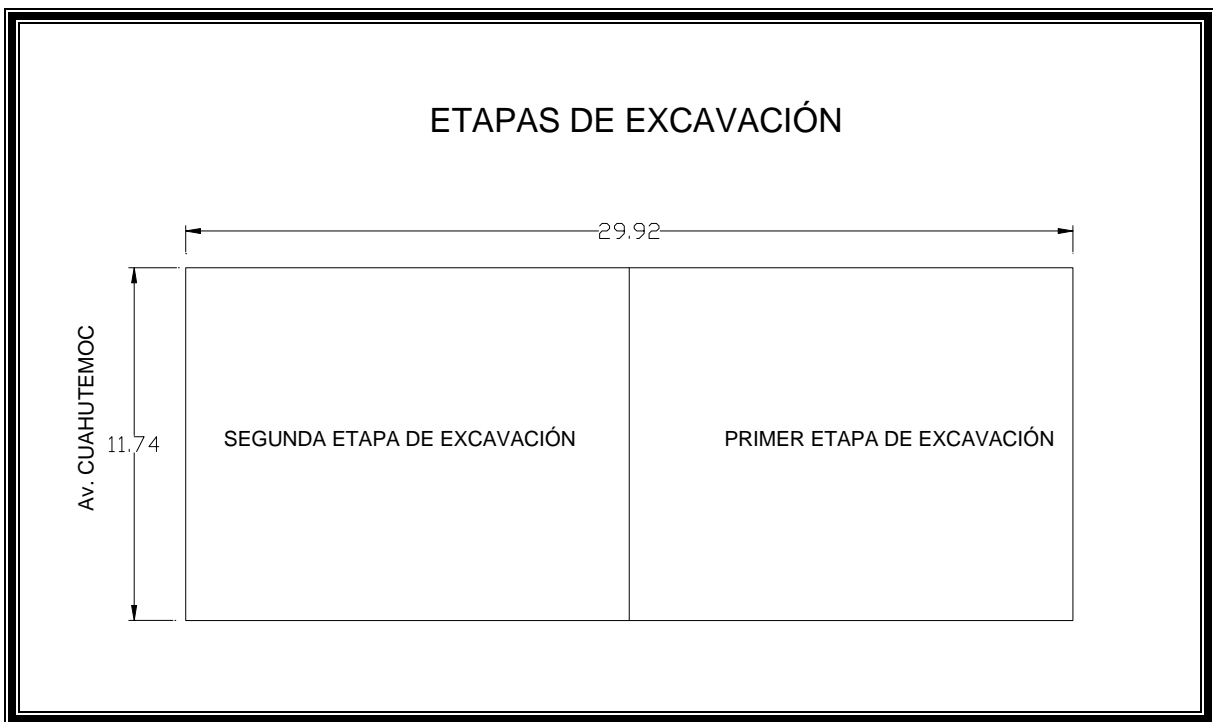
ETAPAS DE EXCAVACIÓN.
